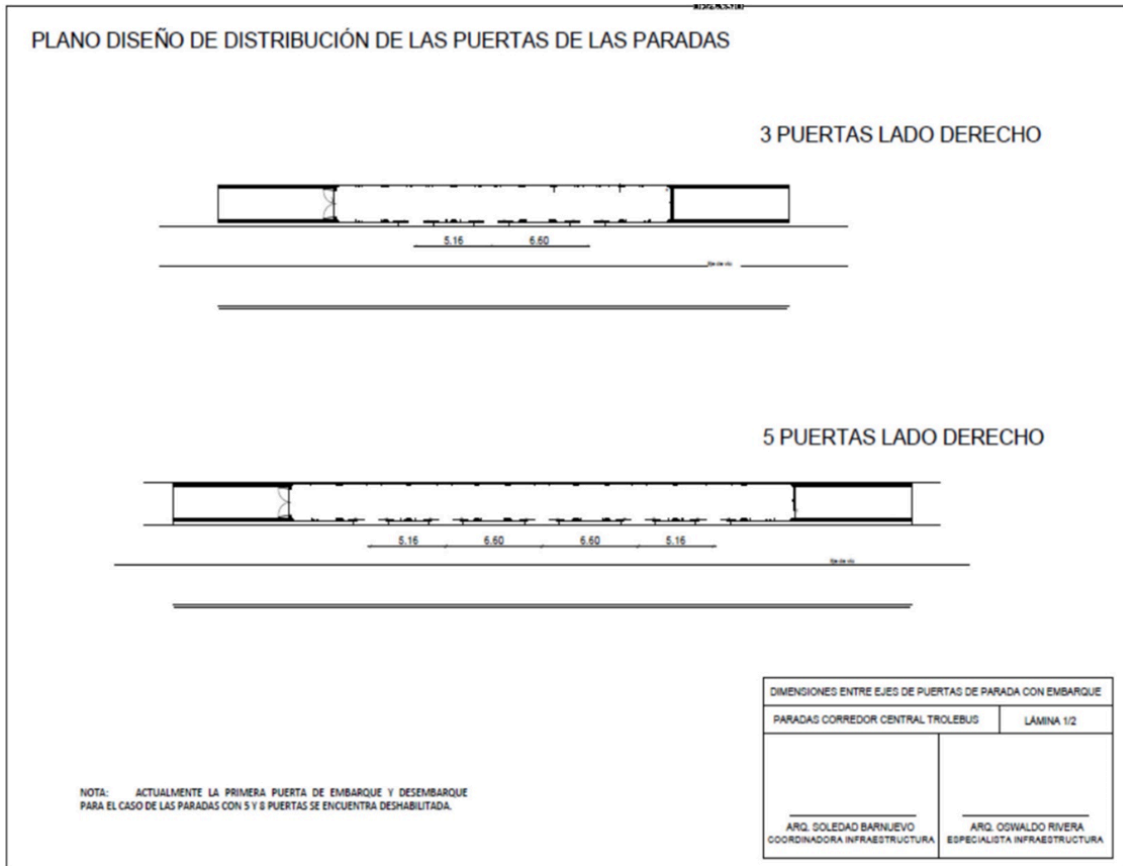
Paradas (estaciones) con 3 y 5 puertas ubicadas a lado derecho
